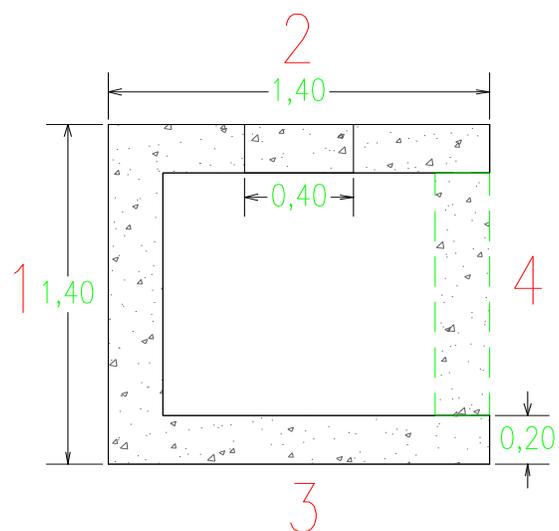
Vista superior de alcantarilla tipo cajón margen izquierdo K0+525. (Fuente: Pasante).
